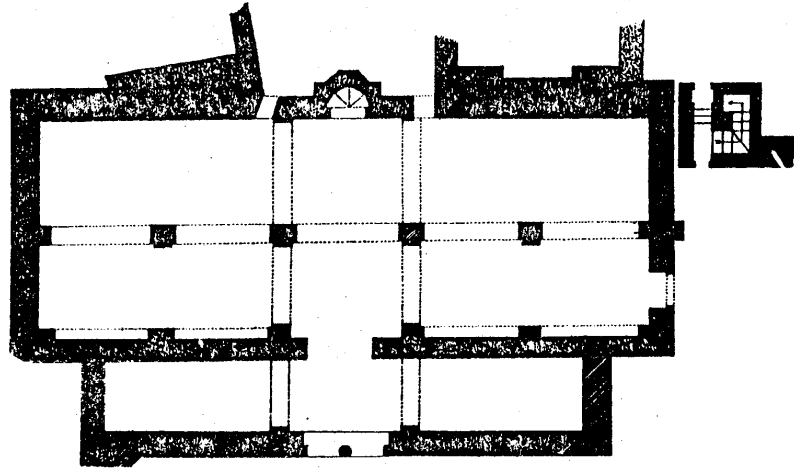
مسقط أفقي لمدرسة الظاهر برقوق (بالتحسين) بالقاهرة .
